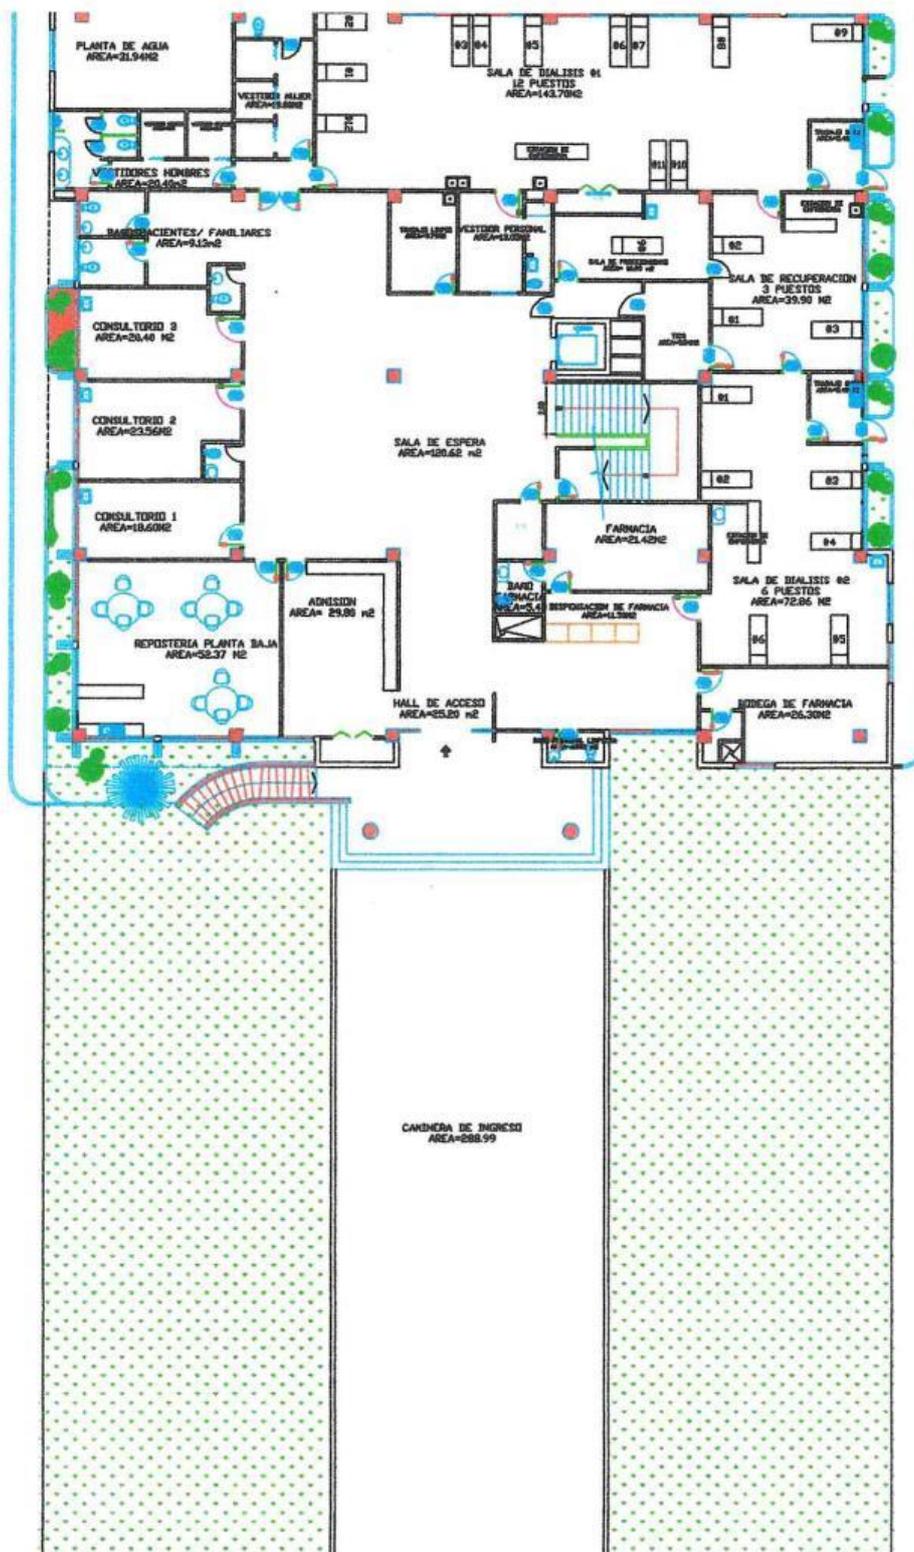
Planos planta baja unidad Especializada Ambulatoria de Hemodiálisis
